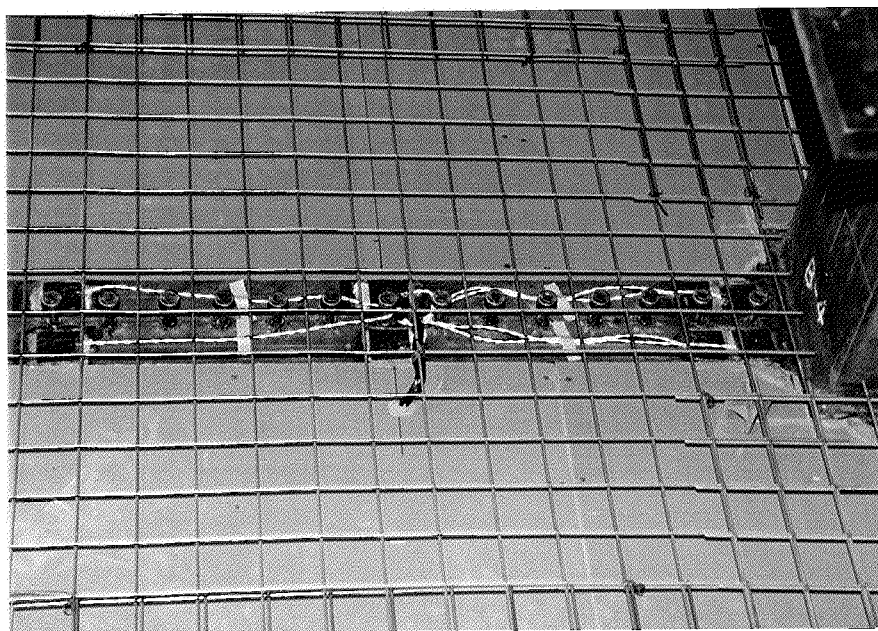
(3) 合成梁・鉄筋コンクリートスラブの配筋状況
